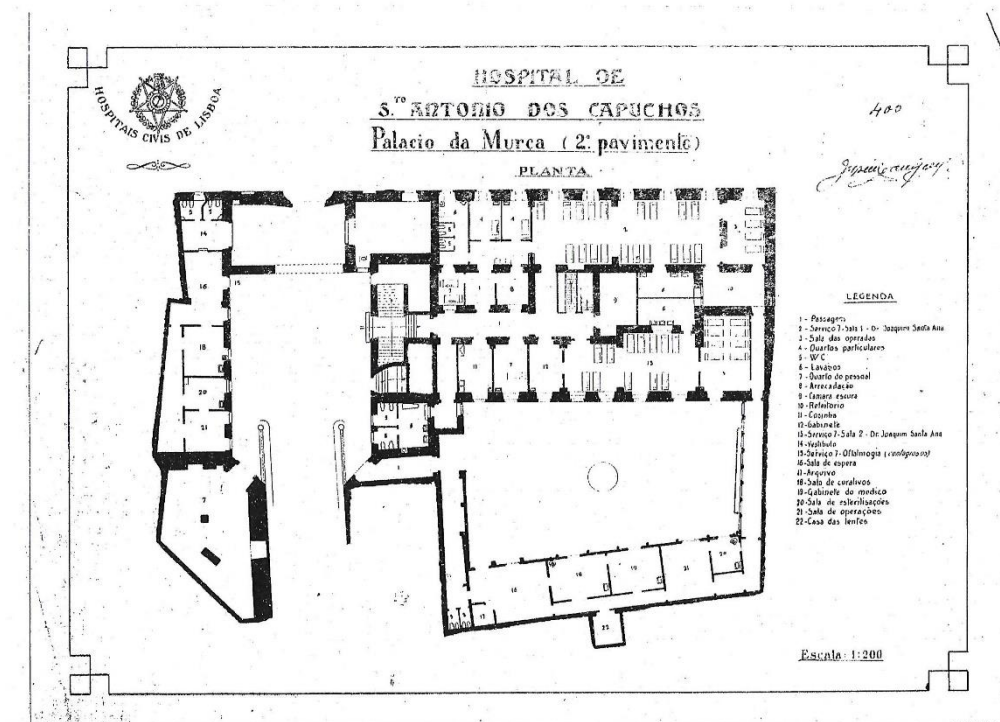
Planta do Antigo Palácio Murça - 2º Pavimento (DGPC/SIPA, Cota: DES 00028071)
